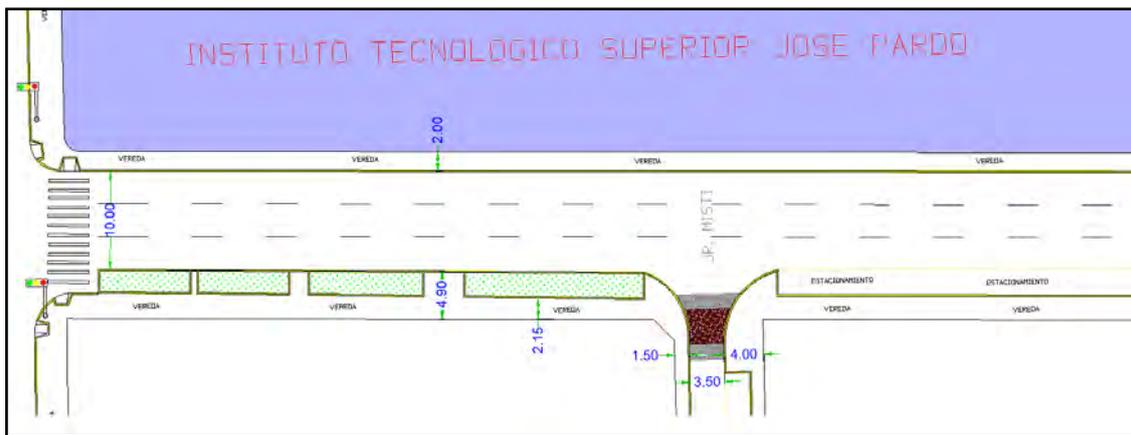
Vista en planta de situación actual en Av. Andahuaylas
